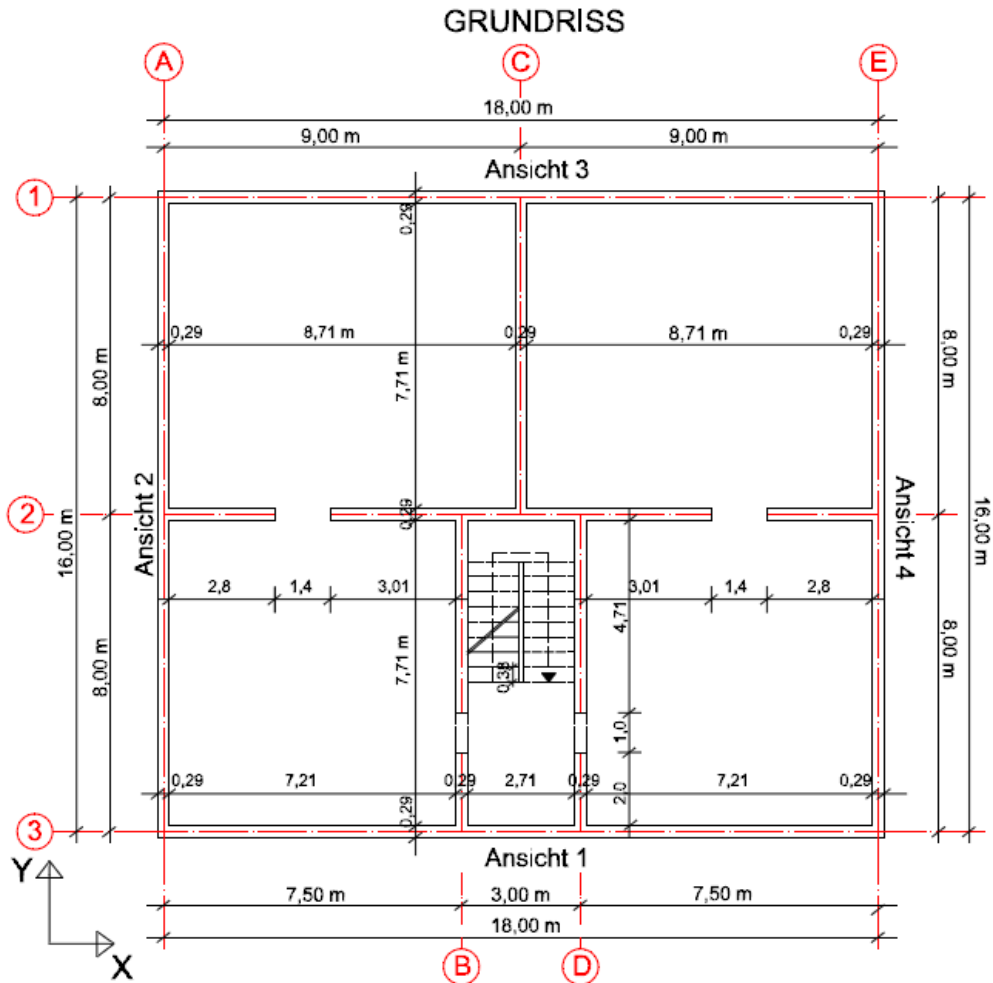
Grundriss mit dazugehörigem Koordinatensystem
